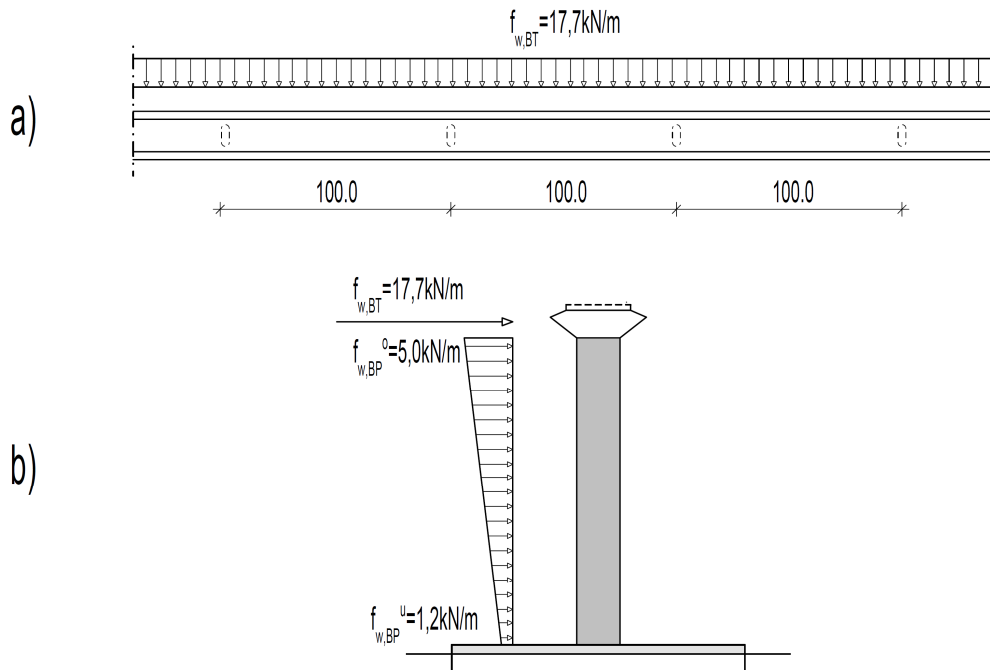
Windlasten auf Brückenträger, a) Draufsicht BT, b) Ansicht-Quer BT-BP-PB
